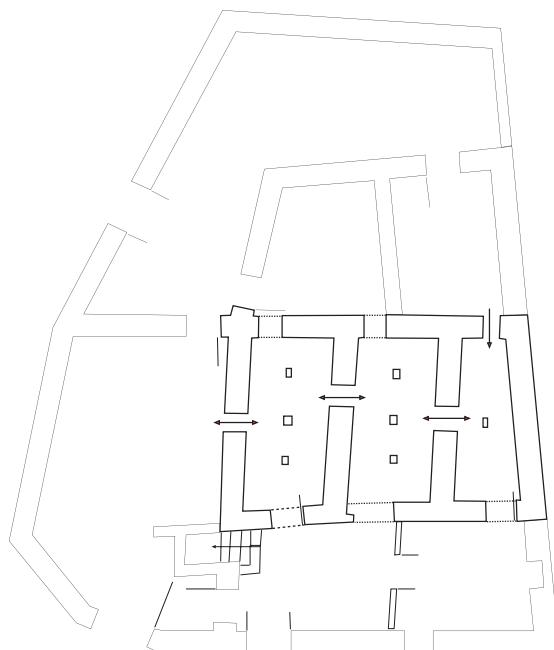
Planta de la vivienda y el baño (según José Javier Álvarez).
